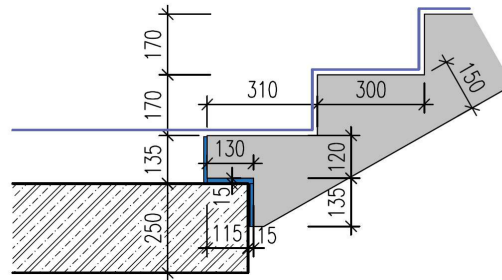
Detail B – uložení nástupního ramene na střední rameno schodiště, Detail C – uložení výstupního ramene na střední rameno schodiště
